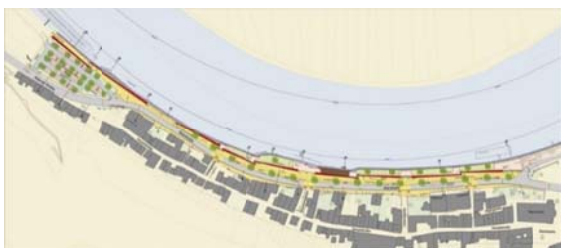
Lageplan des Hochwasserschutzsystems [8]
